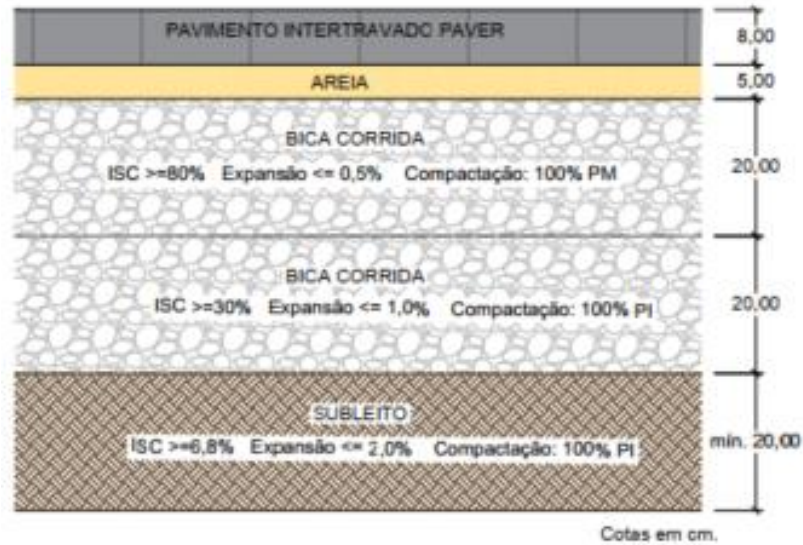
Pavimento Intertravado da Canteiro Central Transponível
